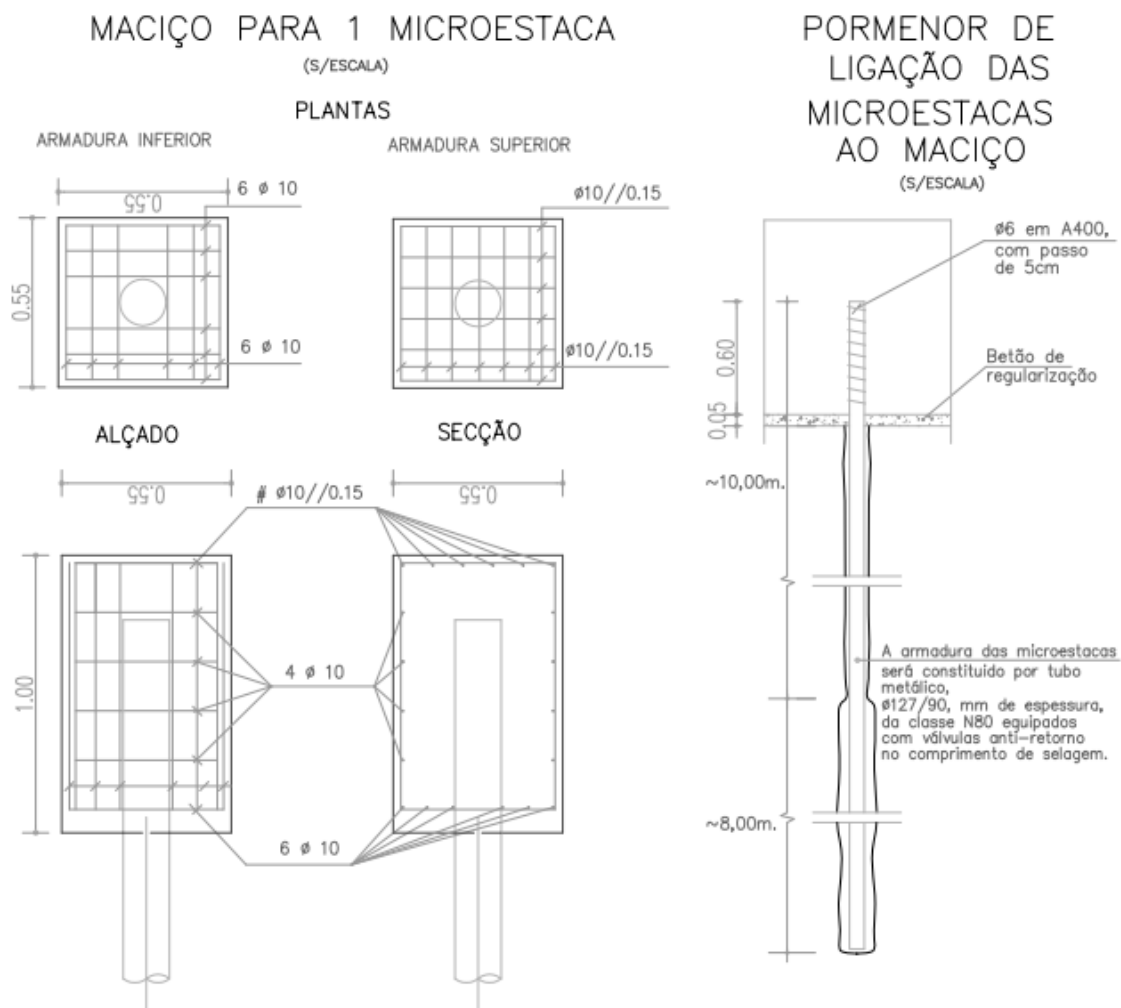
Pormenor dos maciços de encabeçamento. [Fonte: Projeto de Fundações]
